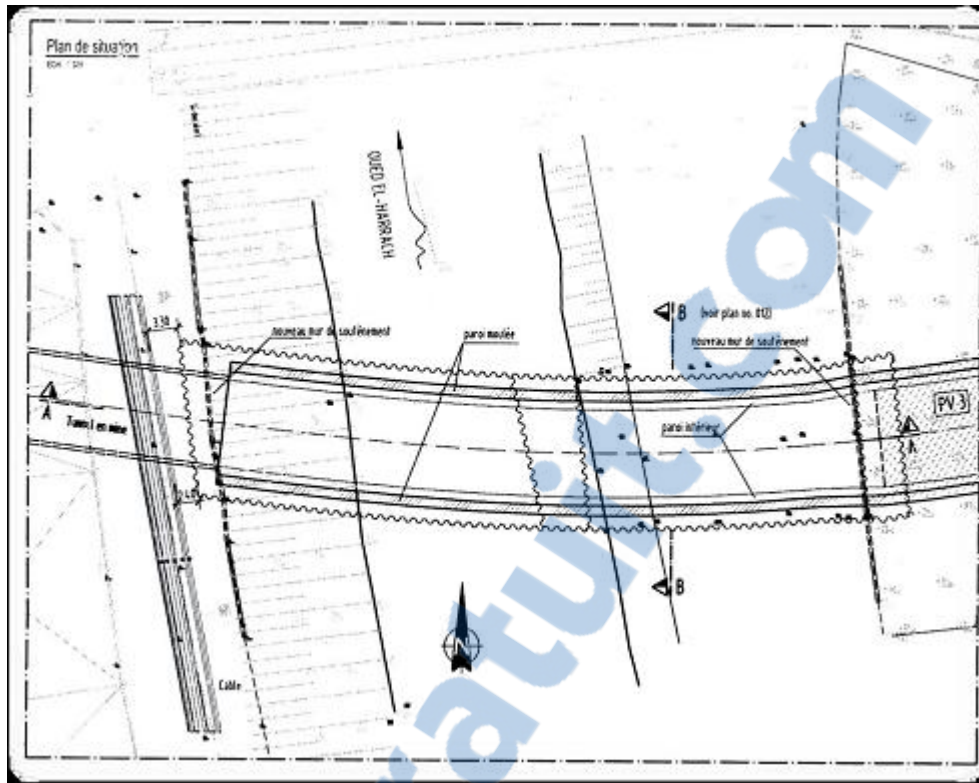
Plan de situation. (Omrani K et Boutria H, 2012)
